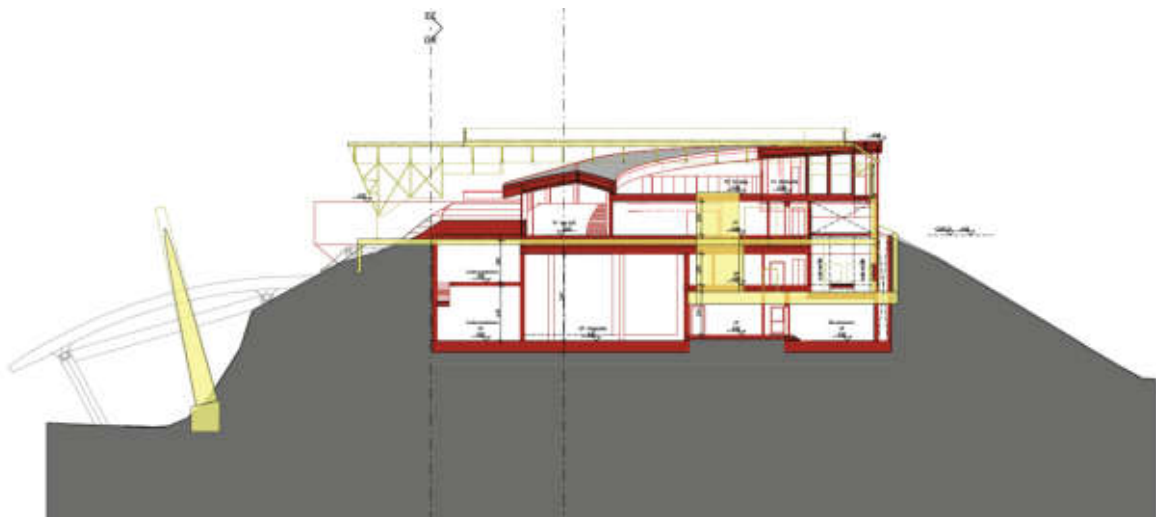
Projektauszug –Schnitt BB – GR -M Bergstation (Arch. Sader) / stralcio da progetto – sezione BB – GR -M stazione di monte (Arch. Sader)
